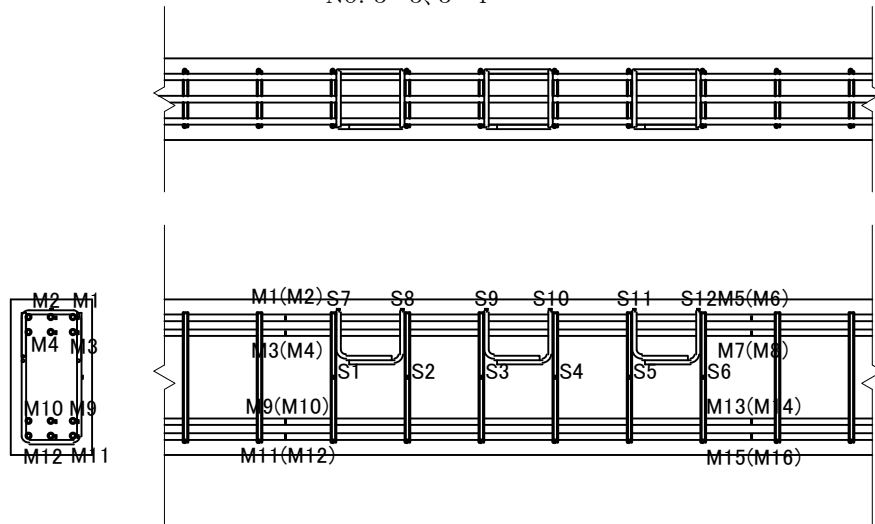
シリーズ2 フェーズ 基礎梁実験のひずみゲージ位置図
